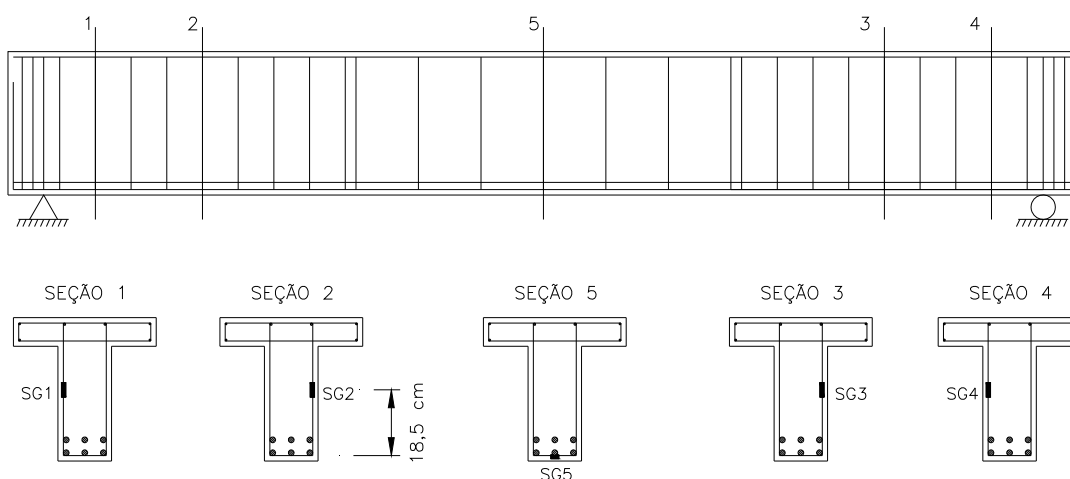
Posicionamento dos EER colados nas armaduras das vigas da Série I.
